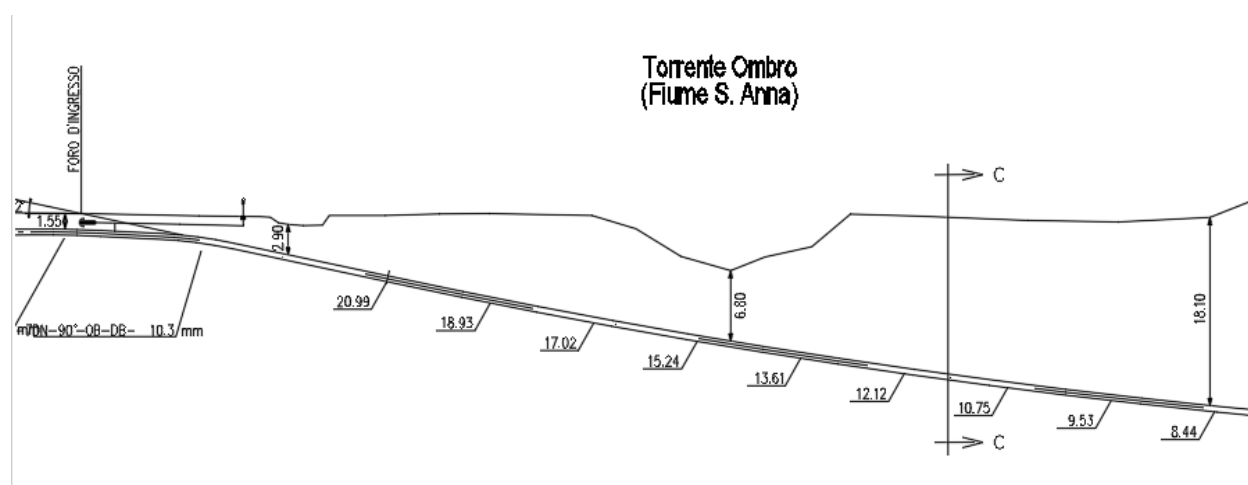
Attraversamento Fiume S. Anna - Sezione schematica di progetto
